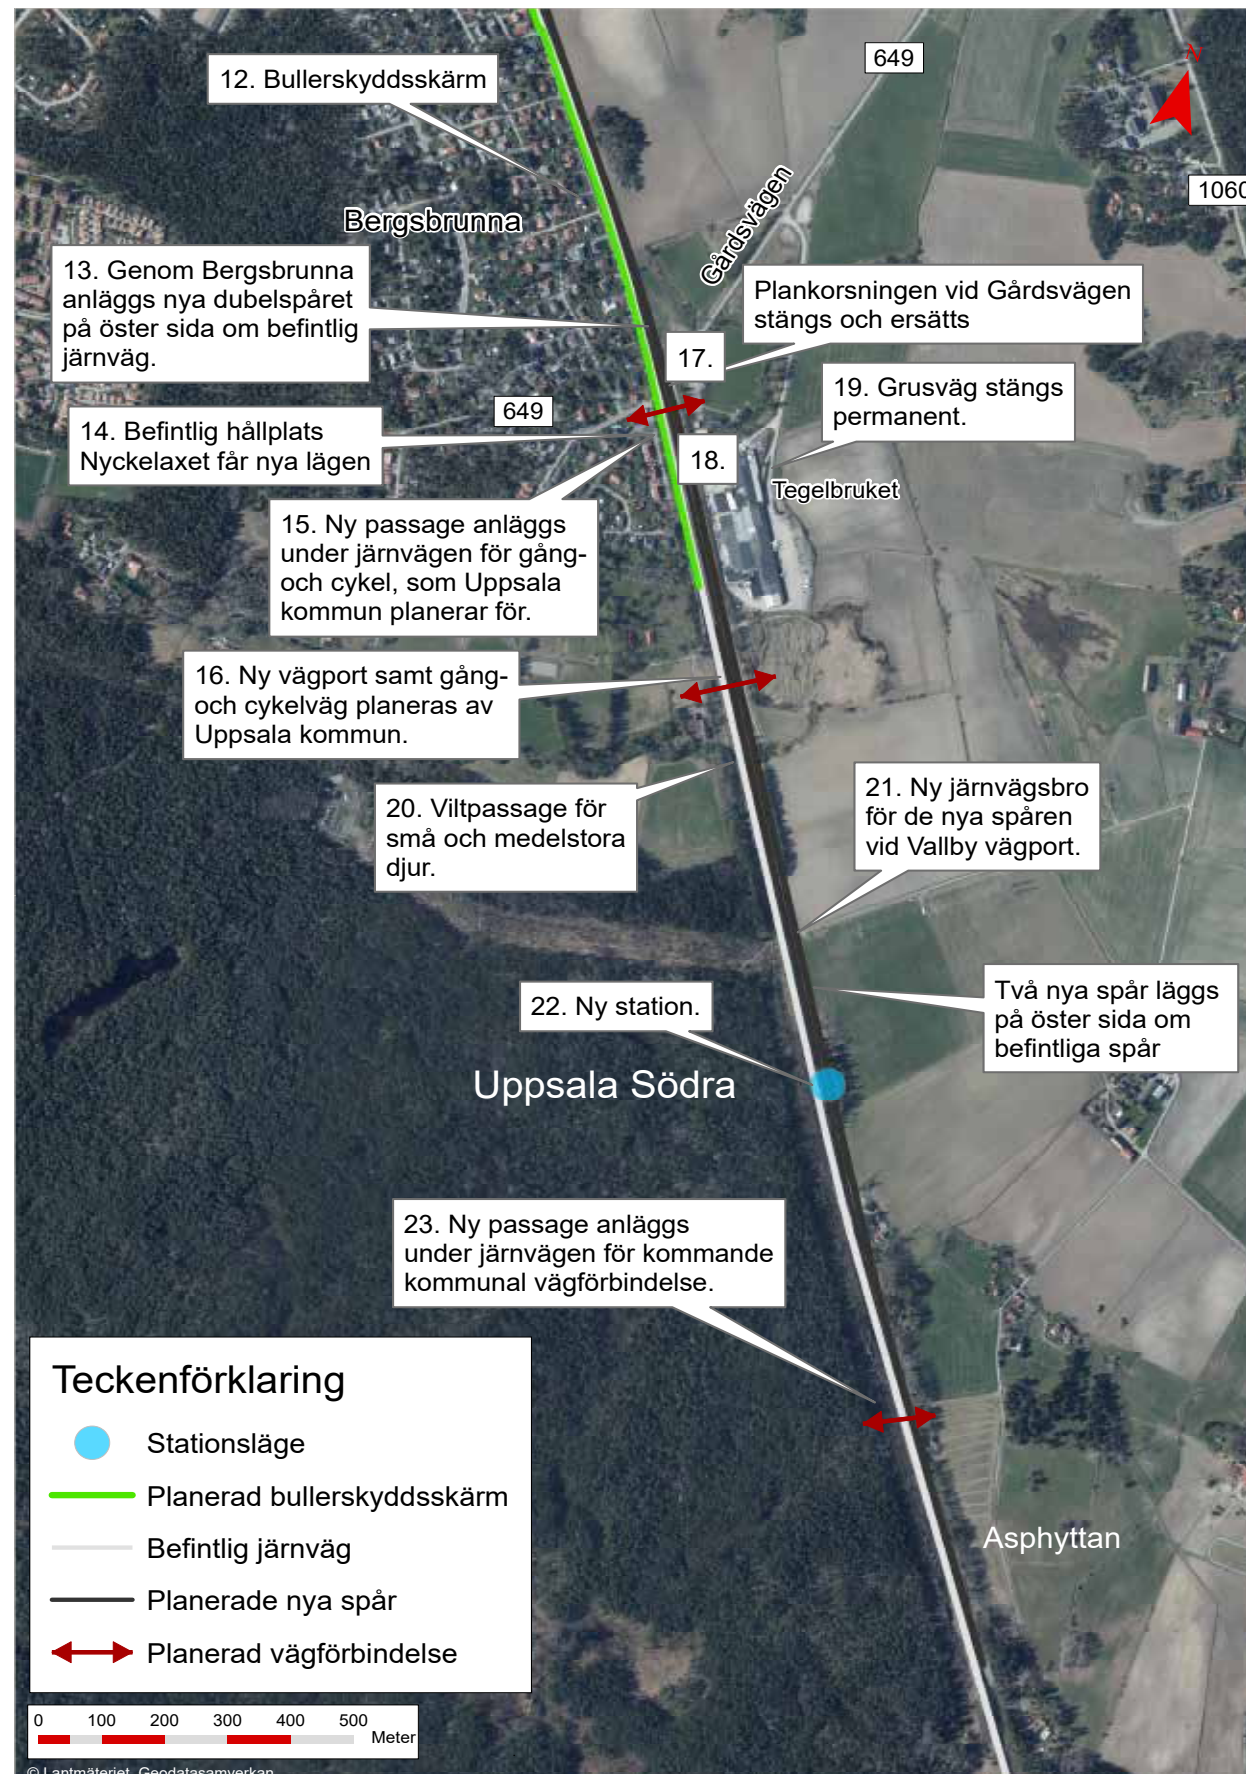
Åtgärder i planförslaget (som är relevanta för barnkonsekvensanalysen) i Kuggebro och Bergsbrunna.
